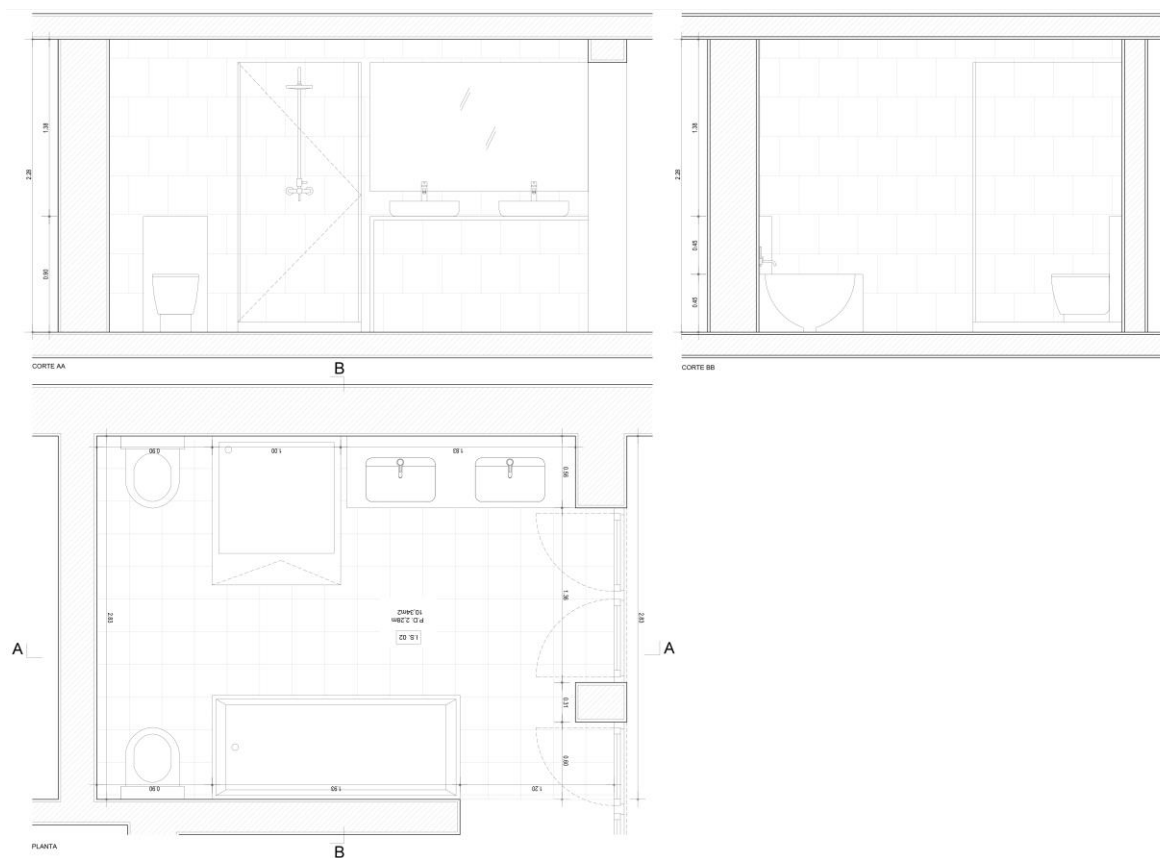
Desenhos do levantamento da instalação sanitária 02. Projecto 5.
